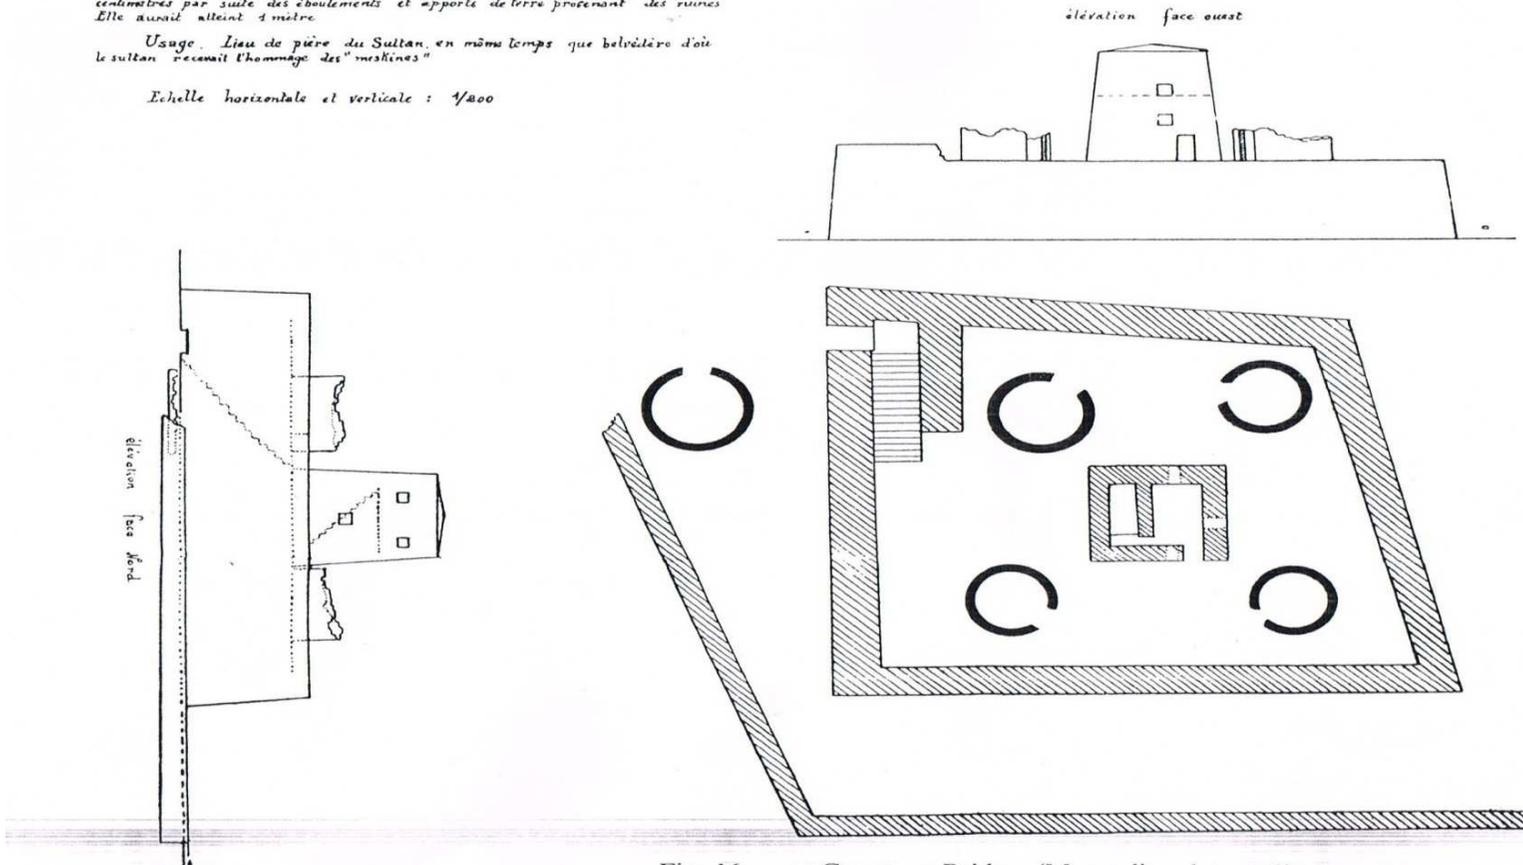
« Goussour Beïda » (Magendie, plan n° 3).
